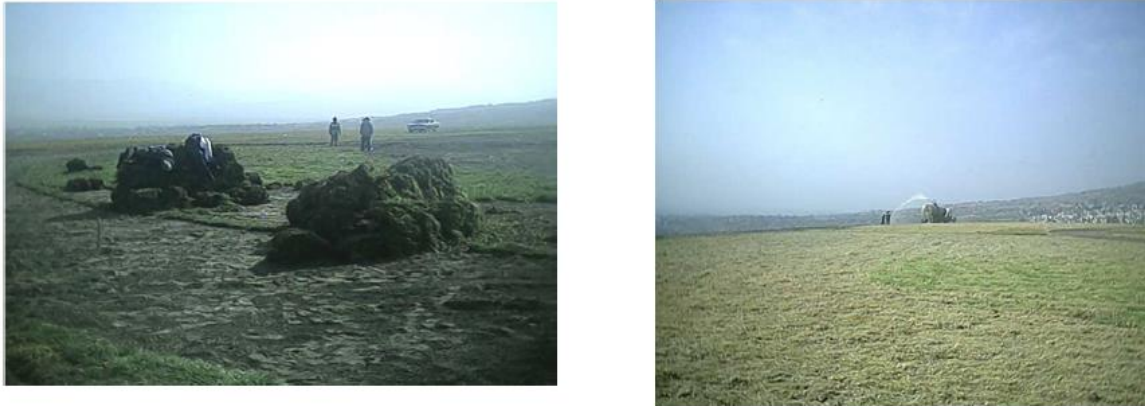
Trabajos de colocación y riego de la cubierta vegetal
